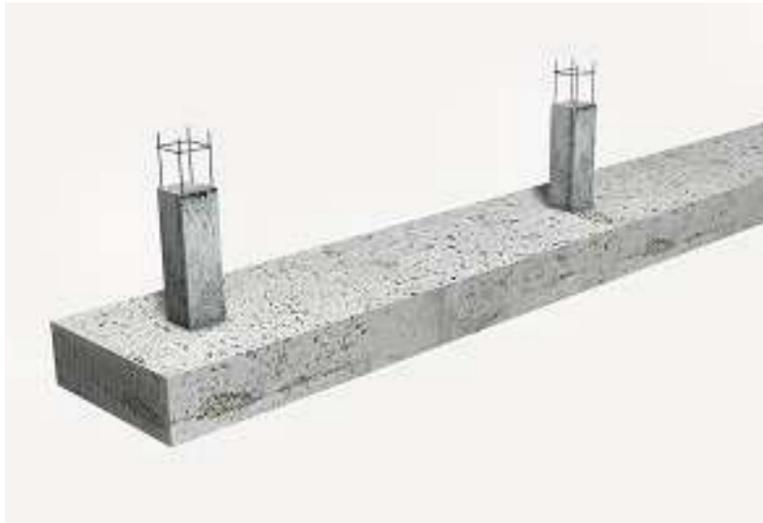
Imagen de zapata corrida bajo pilares de hormigón (www.generadordeprecios.info)
